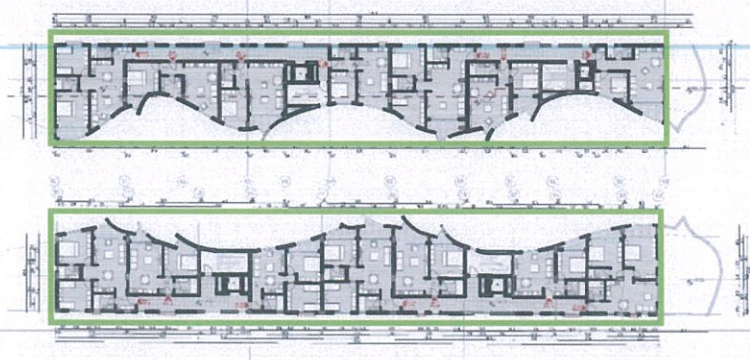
Planimetria e Katit të Katërt _APART - HOTEL
